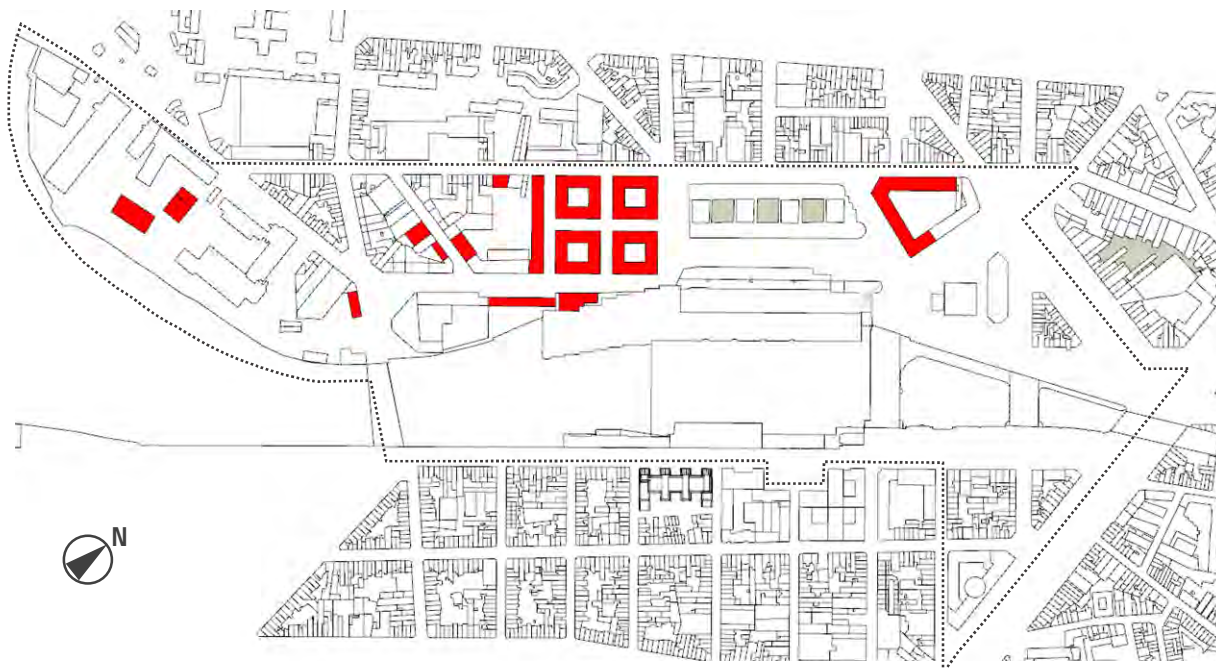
Plan de l'alternative 0 (en rouge, les constructions nouvelles) (L'AUC, 2019)
